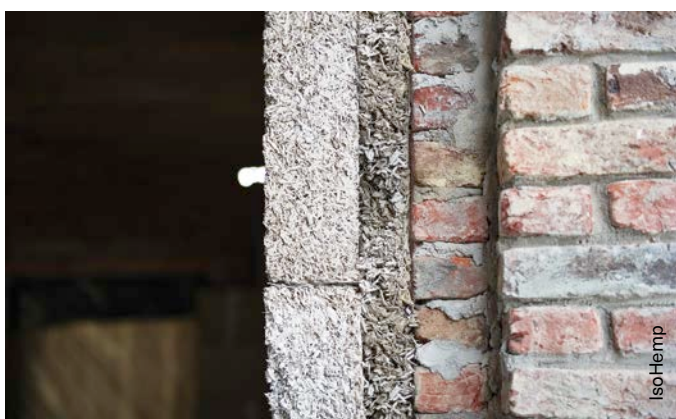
Composition d'un système d'isolation par l'intérieur sans ossature (coupe horizontale).
